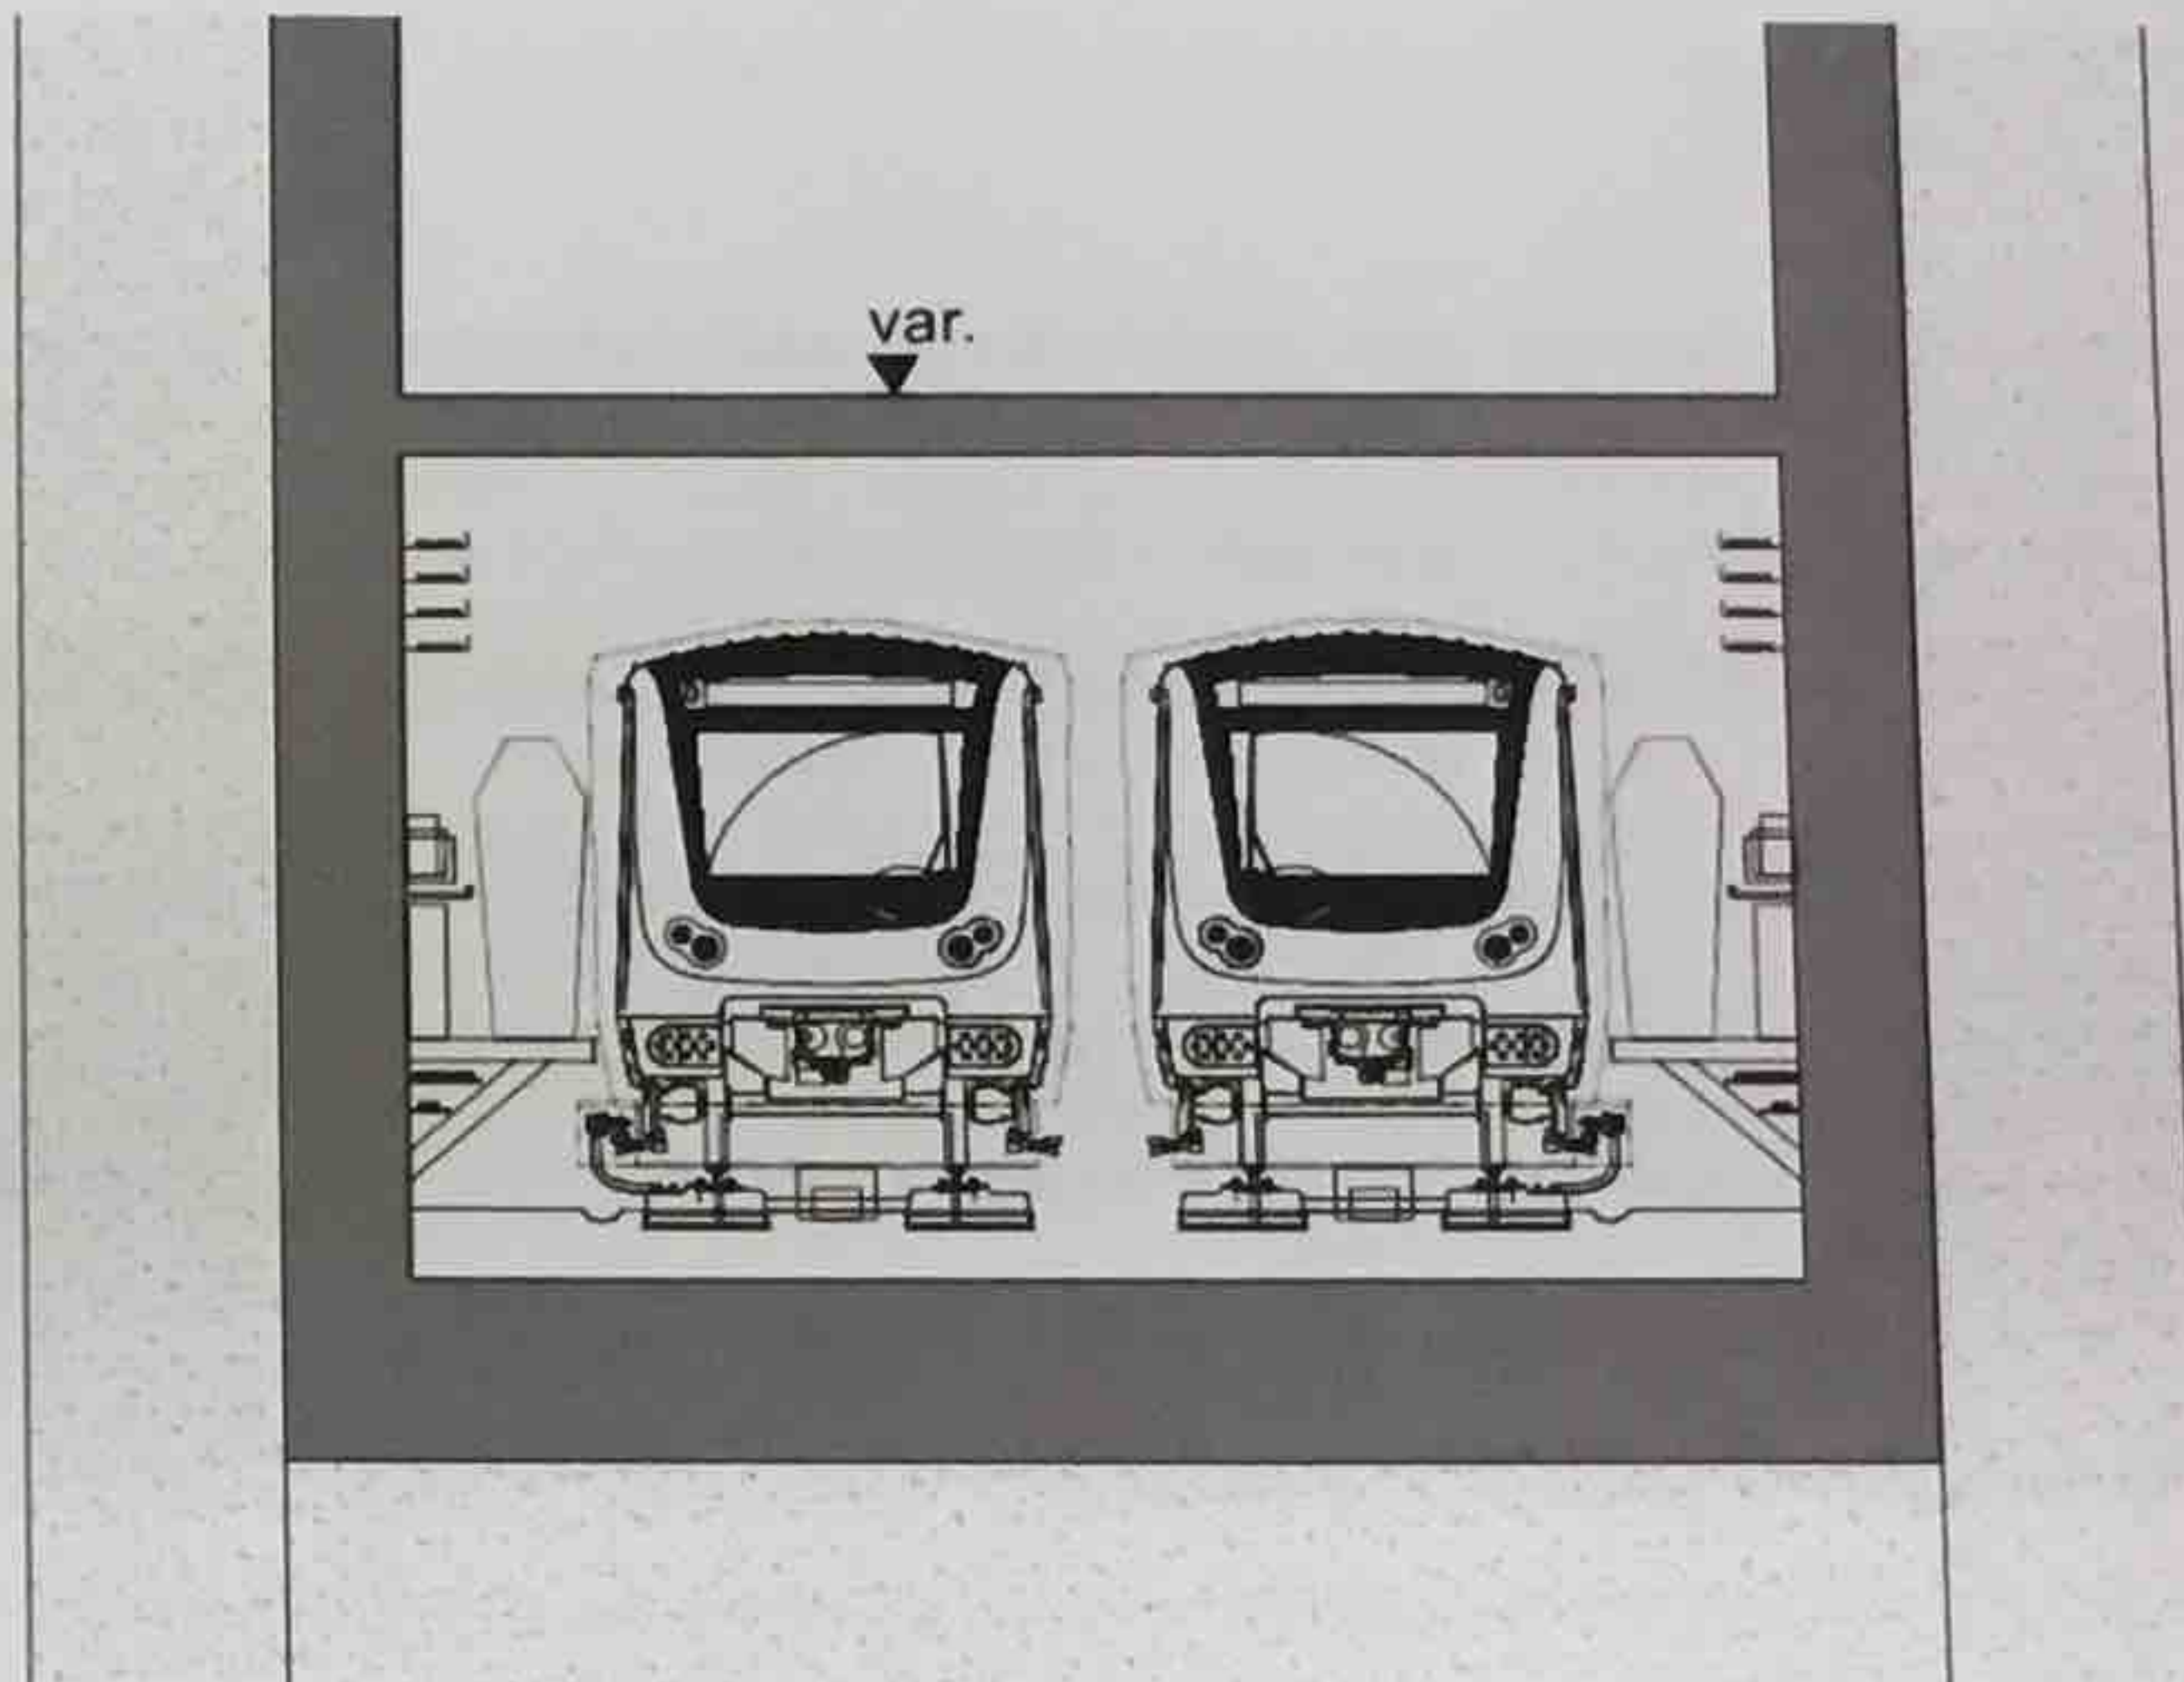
Coupe transversal type du tunnel - Coupe A-A
